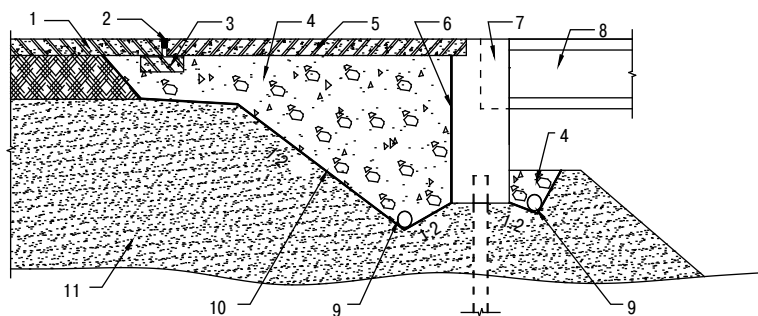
Схема сопряжения при цементобетонном покрытии проезжей части на путепроводе и подходах: 1 – цементобетонное покрытие; 2 – деформационный шов; 3 – лежень; 4 – щебень фракции 20 мм; 5 – переходная плита; 6 – геотекстиль по задней стенке устоя; 7 – тело устоя; 8 – пролетное строение с железобетонной плитой; 9 – дренажная труба 150; 10 – геотекстиль вдоль нижней плоскости щебеночного заполнения; 11 – грунт насыпи; 12 – дорожная одежда подхода
